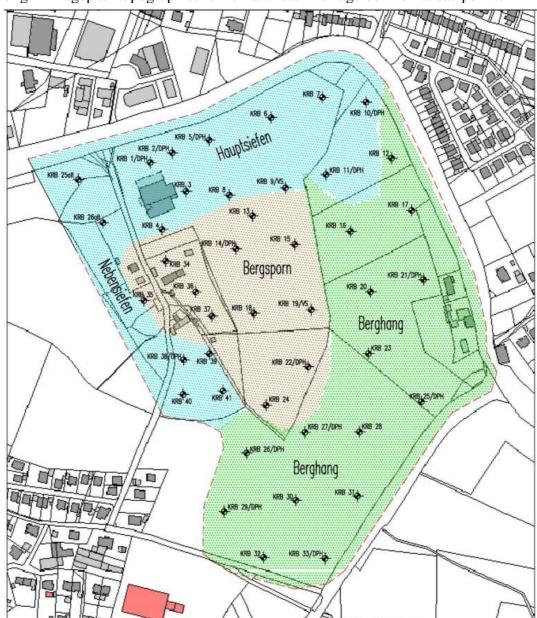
Lageplan topographische Verhältnisse mit Lage der Bohransatzpunkte
